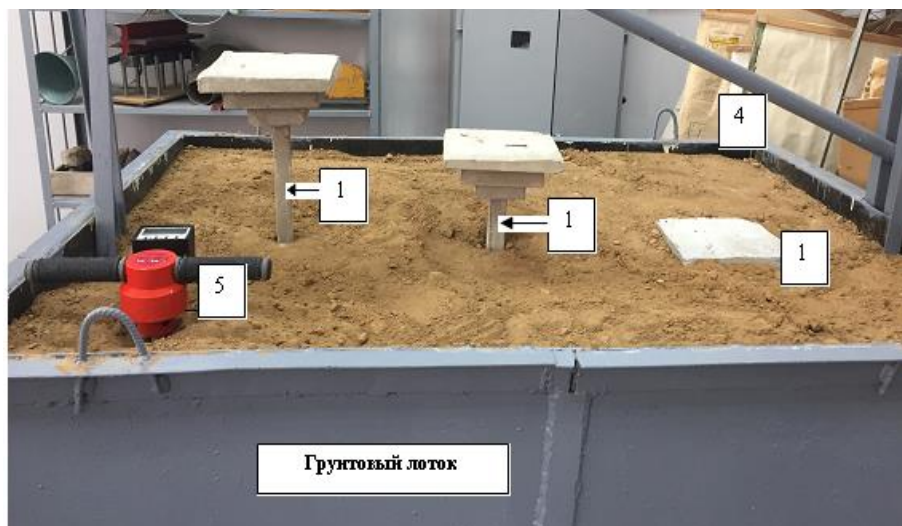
Подготовка лабораторной установки для испытания группы ступенчатых свай:
